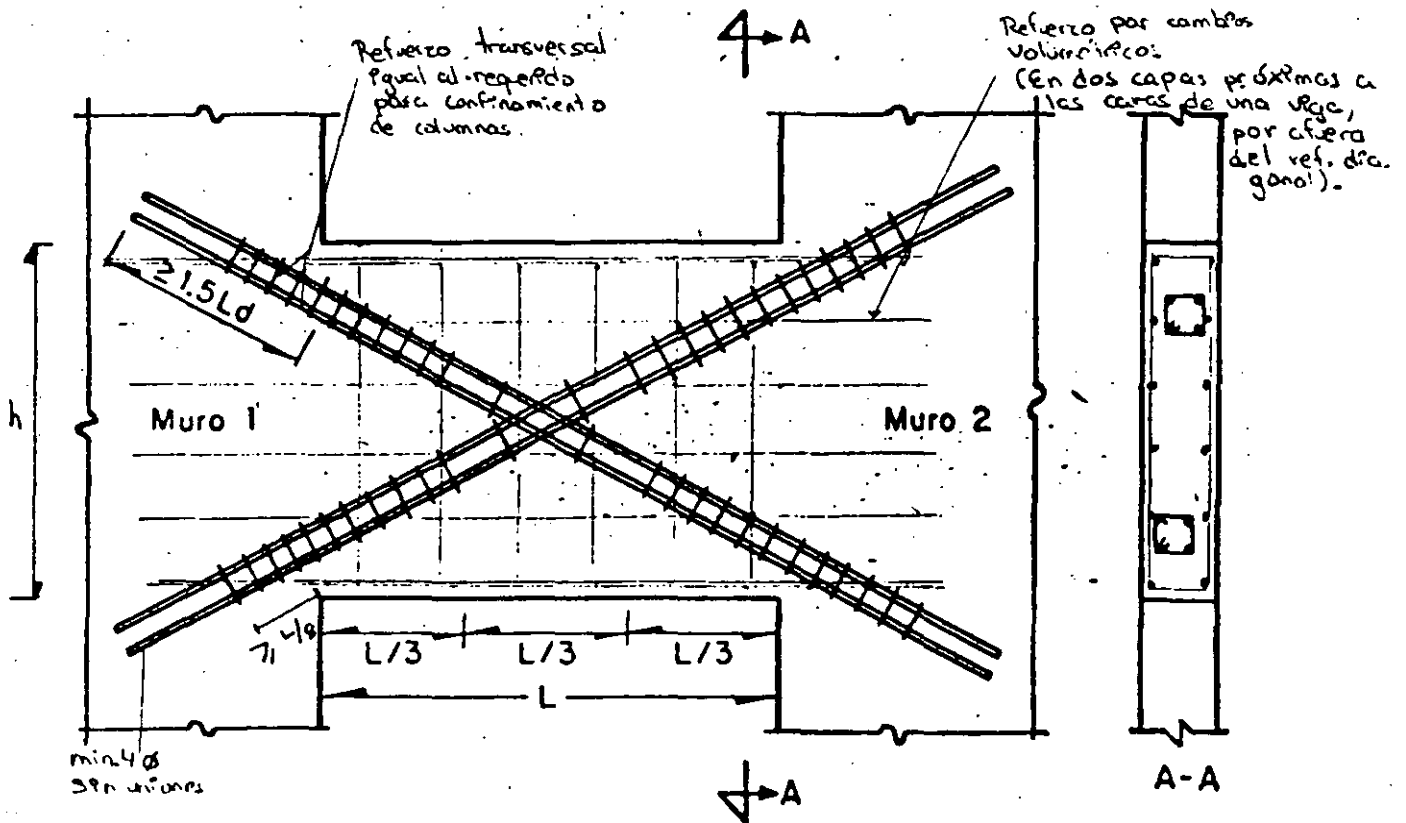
Refuerzo de viga de acoplamiento que une muros de concreto. (norma 1/n/a)
